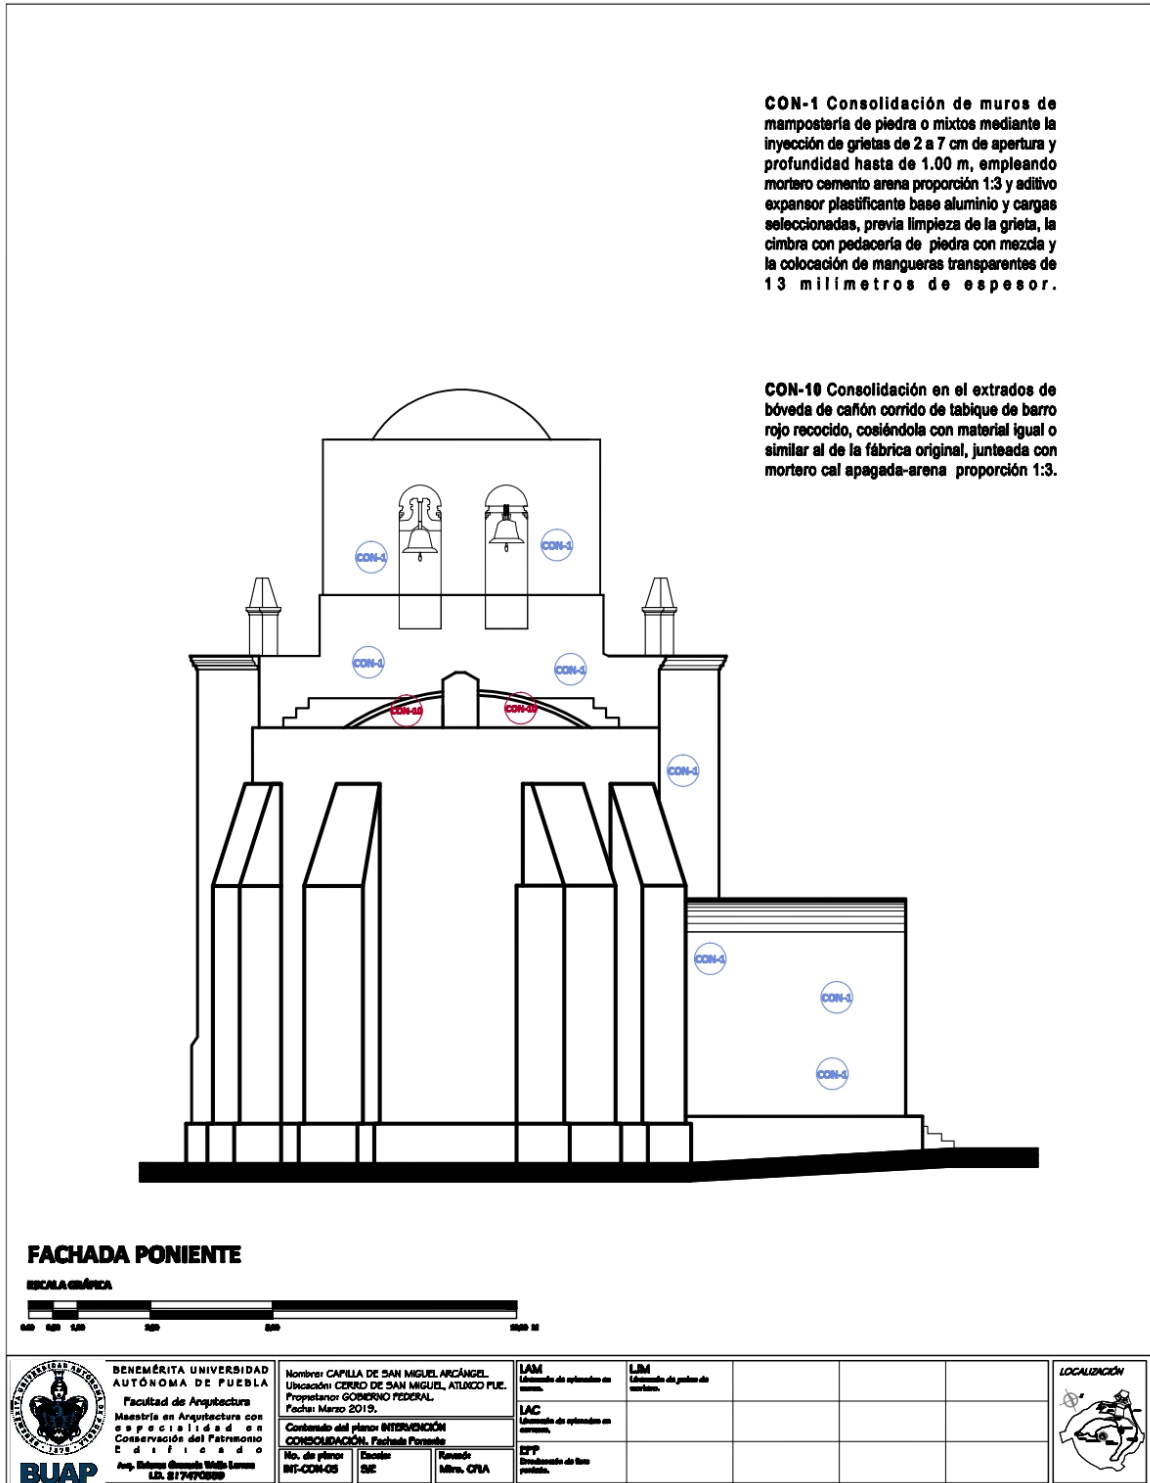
Plano 6 de consolidaciones en fachada poniente (posterior).
